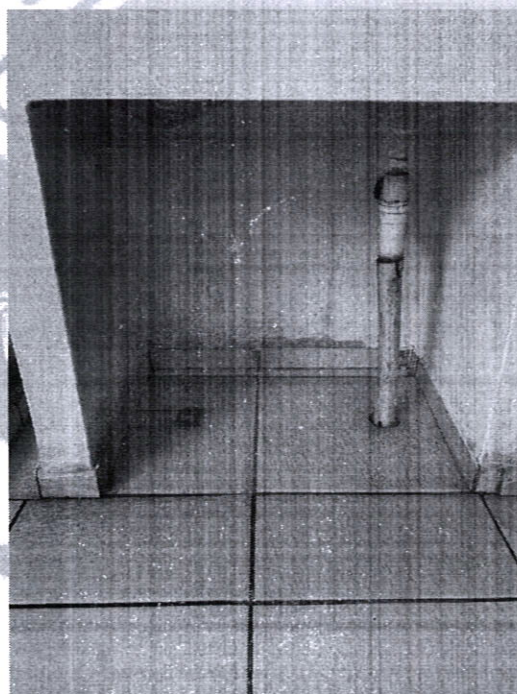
Vistas de necessidade de instalação de tubulação de esgoto.
